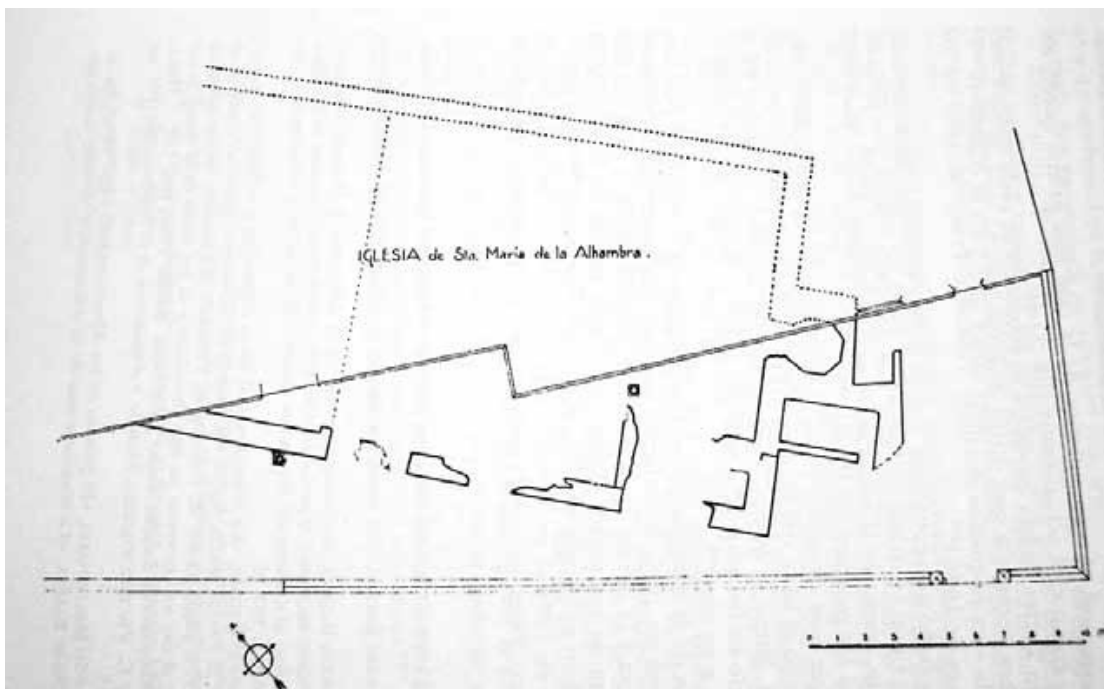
Plano de excavación de la mezquita Mayor de la Alhambra. Modesto Cendoya 1922
